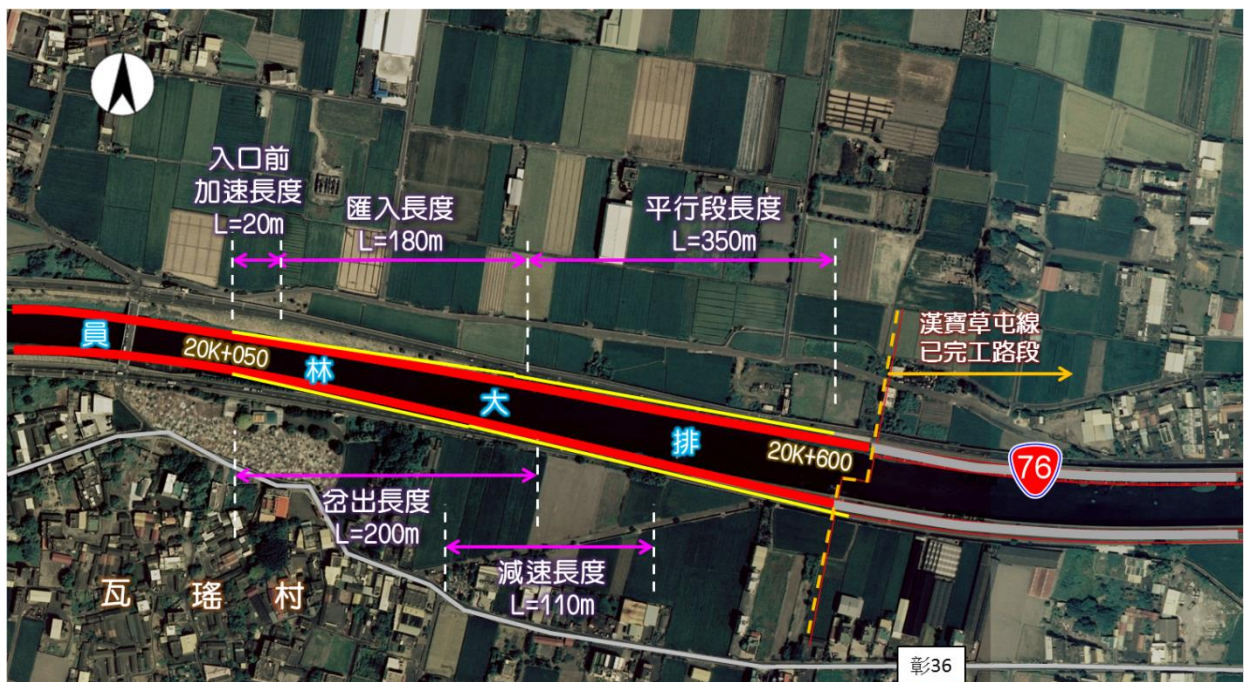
台 19 地區服務性交流道平面配置示意圖
